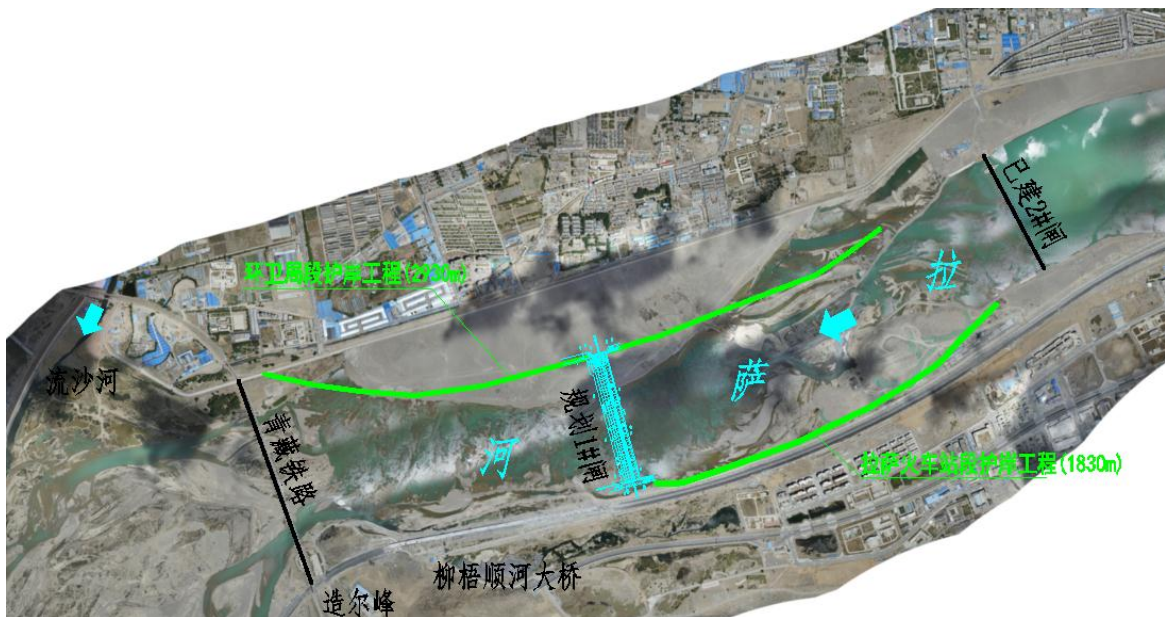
环卫局段与拉萨火车站段护岸工程平面布置示意图
